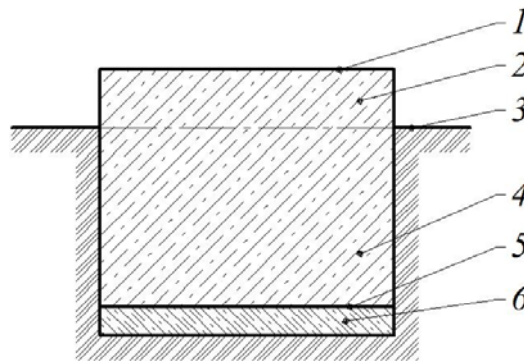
Основні складові фундаменту: 1 – дзеркало фундаменту; 2 – надземна частина; 3 – поверхня ґрунту; 4 – підземна частина; 5 – підшва фундаменту; 6 – основа фундаменту
